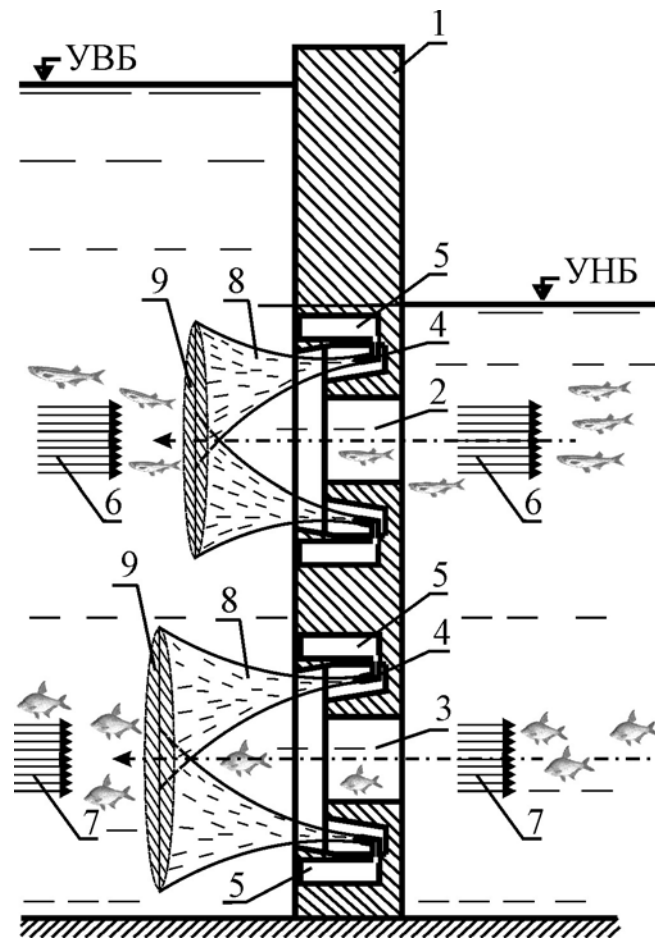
Схема входной разделительной стенки (входного оголовка) на разрезе: 1 – входная разделительная стенка (входной оголовок); 2 – вливное отверстие верхнего яруса; 3 – вливное отверстие нижнего яруса; 4 – струеобразующие насадки; 5 – напорные коллекторы; 6 – привлекающий поток в верхнем слое водотока; 7 – привлекающий поток в нижнем слое водотока; 8 – гидравлические струи; 9 – зона «частично равных давлений»
